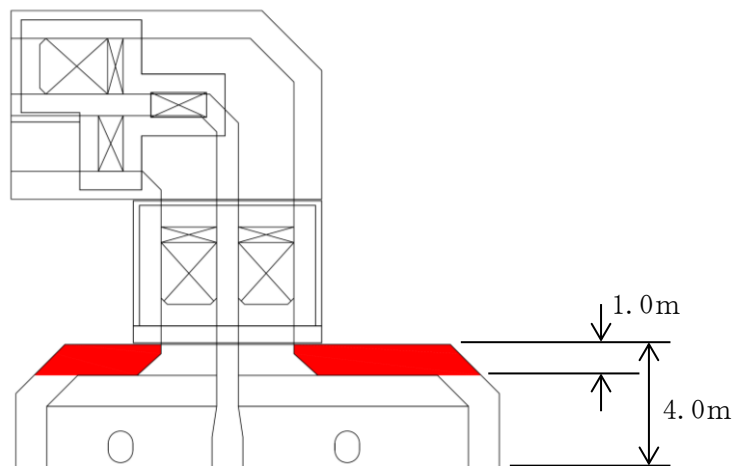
補機冷却用海水取水路の平面図 (A-A断面, 北側構造物拡大)
